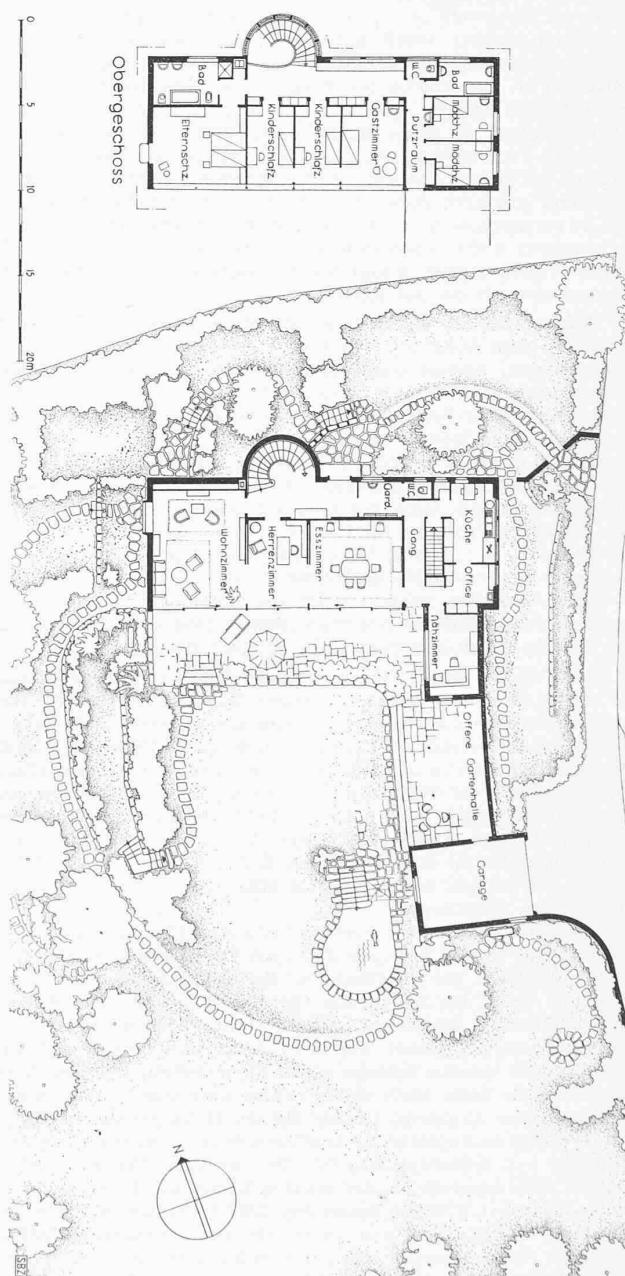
Grundrisse 1:400 des Wohnhauses am Zürichberg
